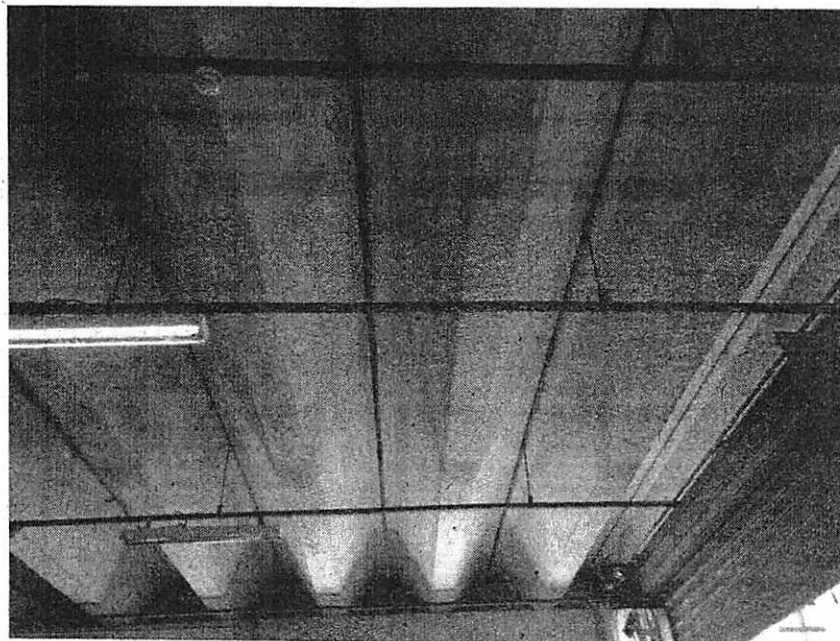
Vista do telhado tipo canaletão apoiadas na estrutura mista de concreto armado/pré fabricado.
